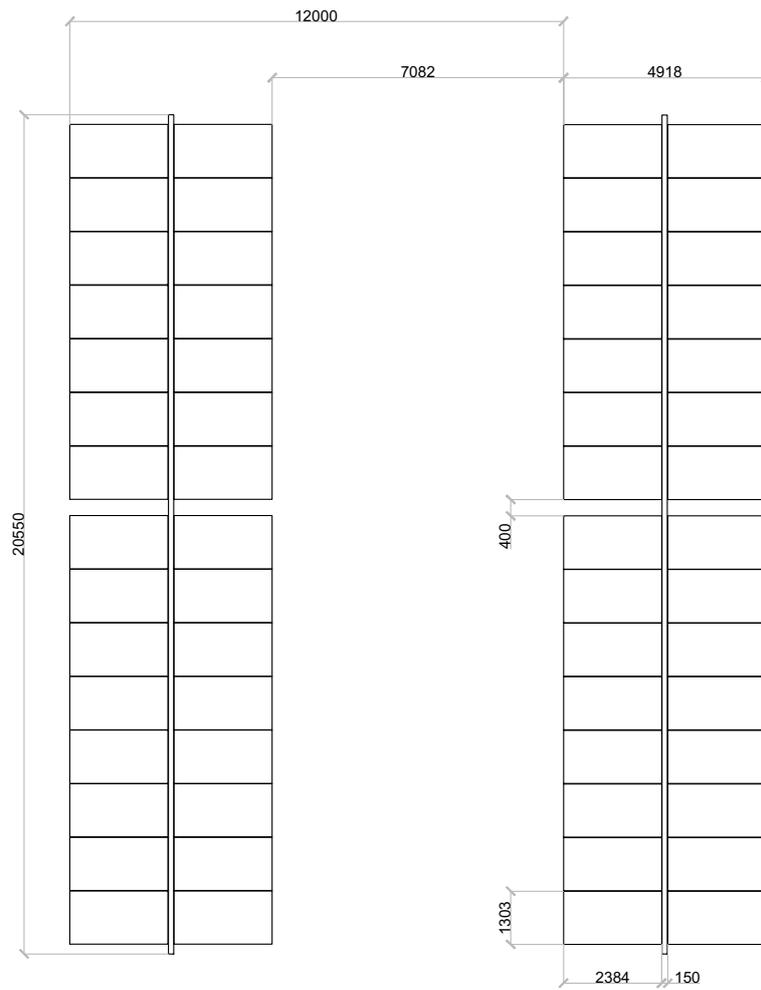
Vista in pianta delle stringhe fotovoltaiche previste a progetto
